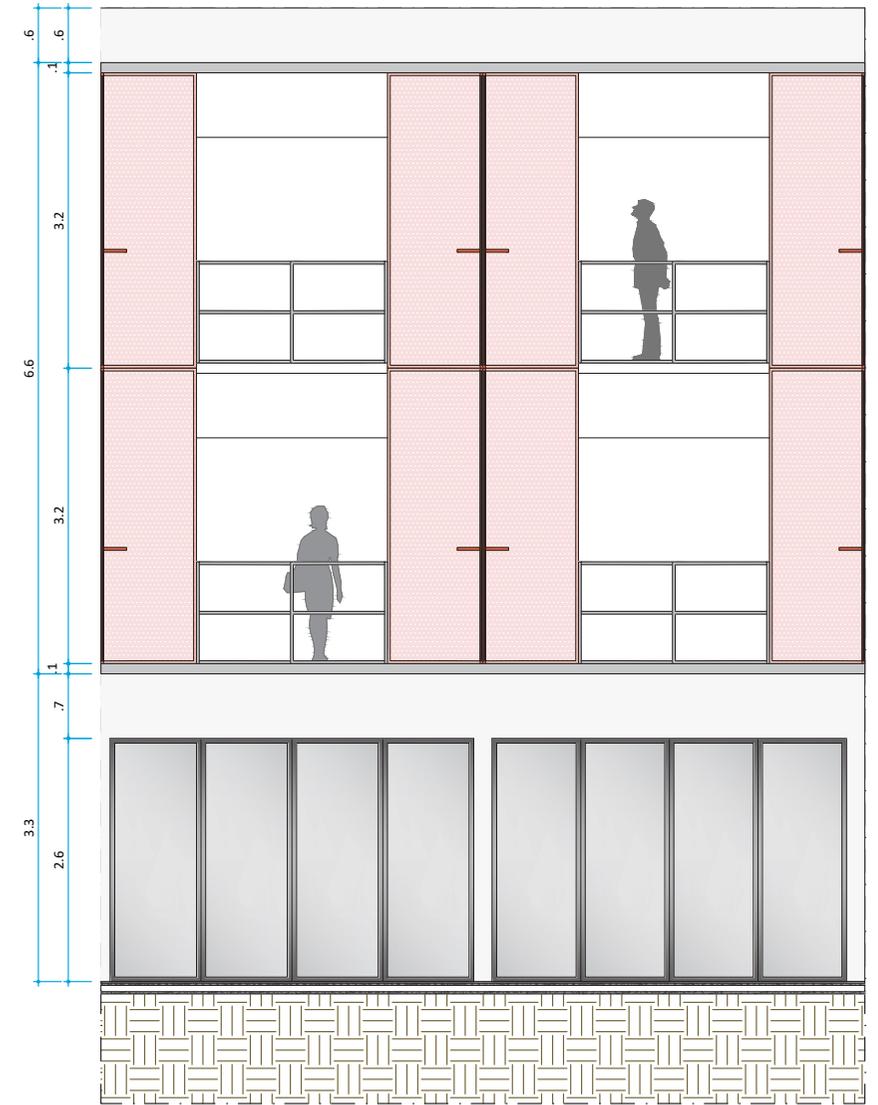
Detalhamento de Fachada - Vista Varandas Abertas
